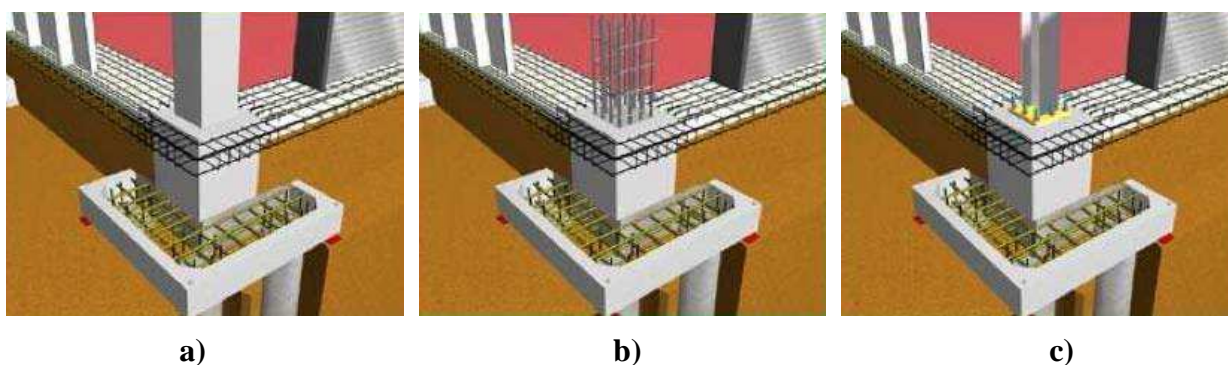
Particolari costruttivi di una fondazione prefabbricata adoperata per la realizzazione di una struttura in elevazione prefabbricata in cemento armato (a); gettata in opera (b); in acciaio.
